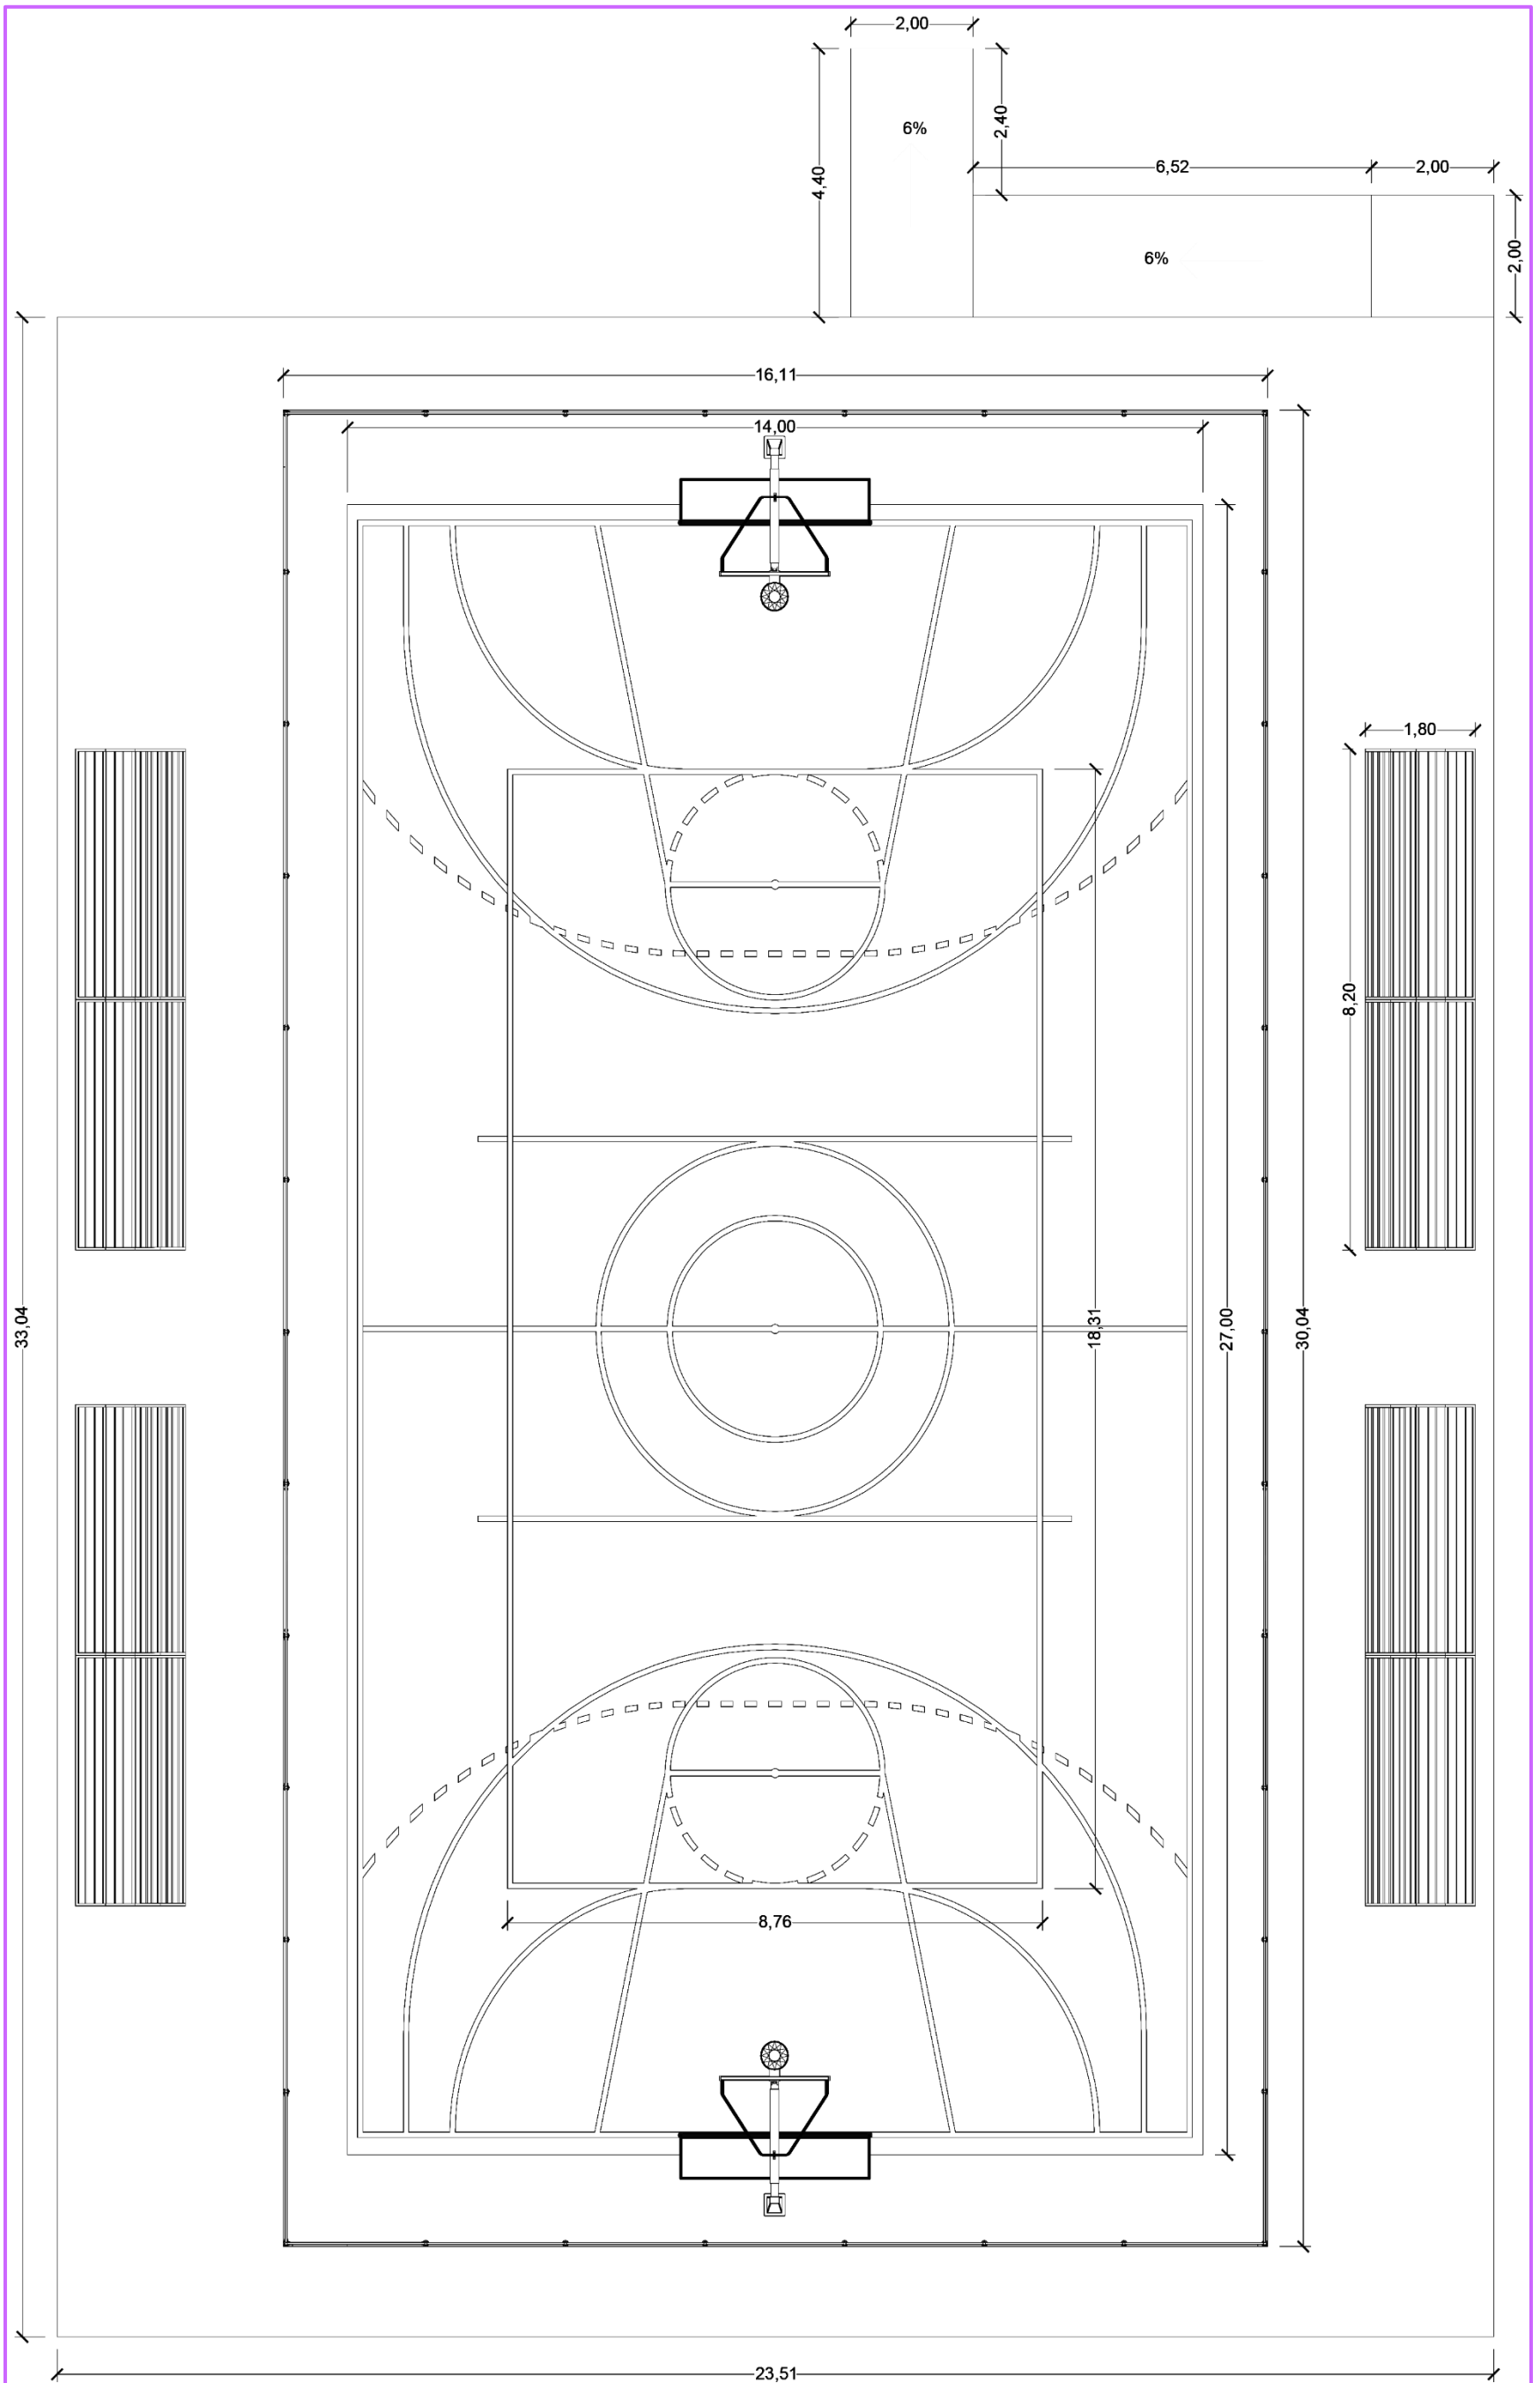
Detalle C. Plano técnico de canchas multiuso.
